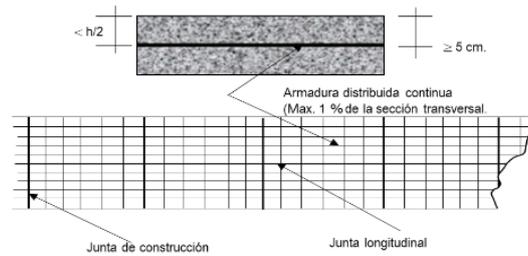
Pavimentos de concreto con refuerzo de Acero Continuo
